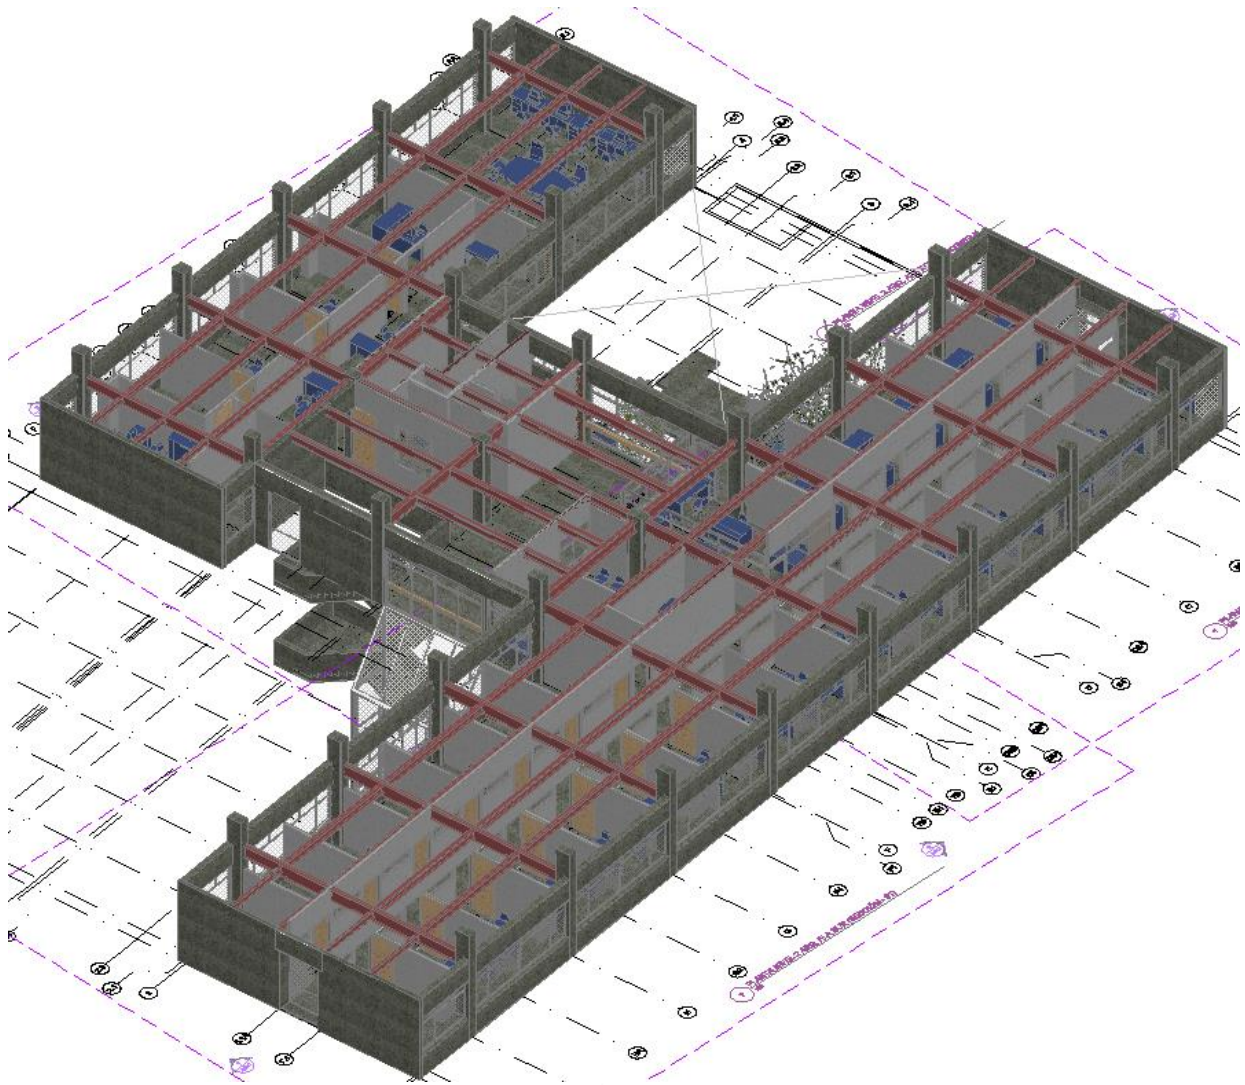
Vista arquitectónica en 3D incluyendo la estructura de acero.
